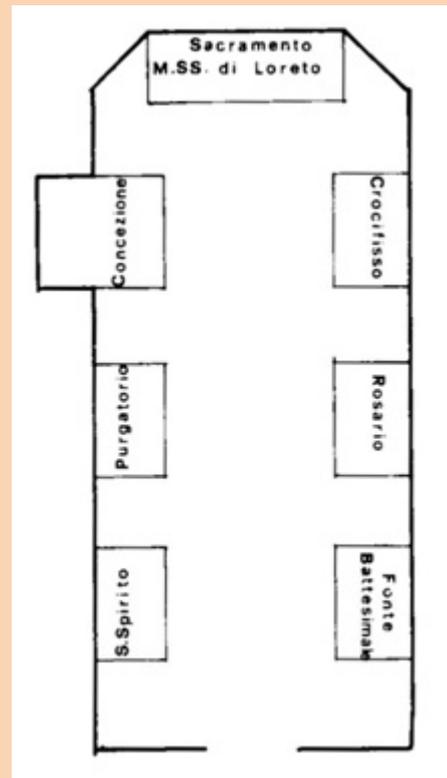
schema planimetrico della chiesa S. Maria di Loreto di Delia al 1669
